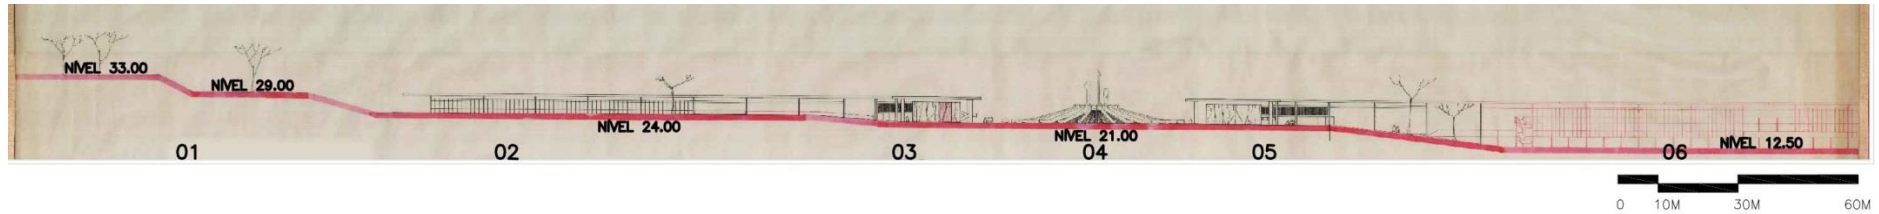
Elevação Norte Plano UMA. Fonte: Pranchas 09 e 10 do Plano de Implantação Imediata – 1º Sub-Etapa Plano UMA – Arquivo digital disponível no COMCAP-UEM.
